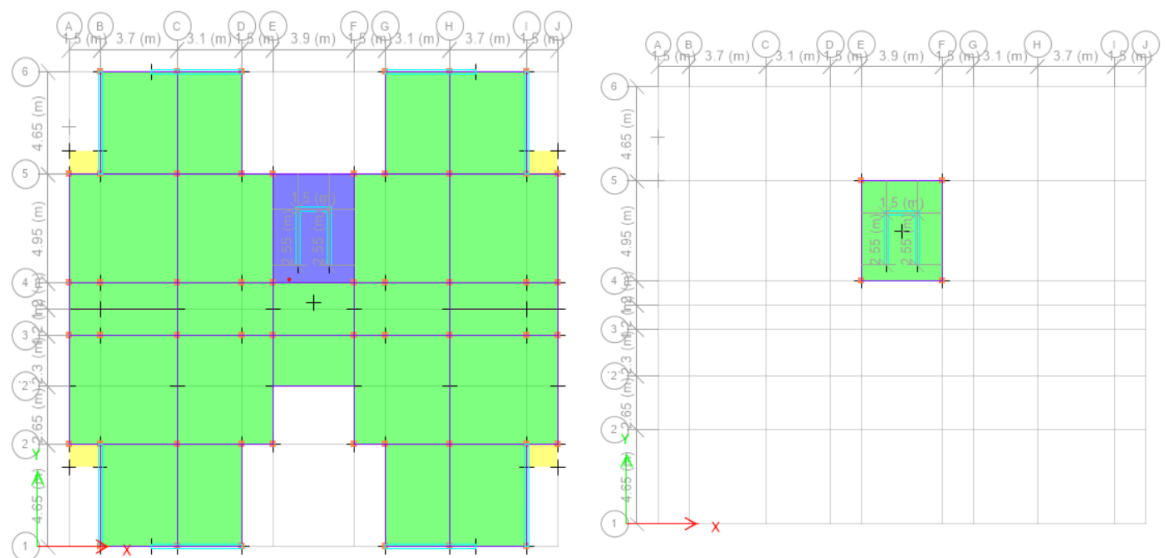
Vues en plan : terrasse (niv. 33.66 m) et locale technique (niv. 36.72 m)
